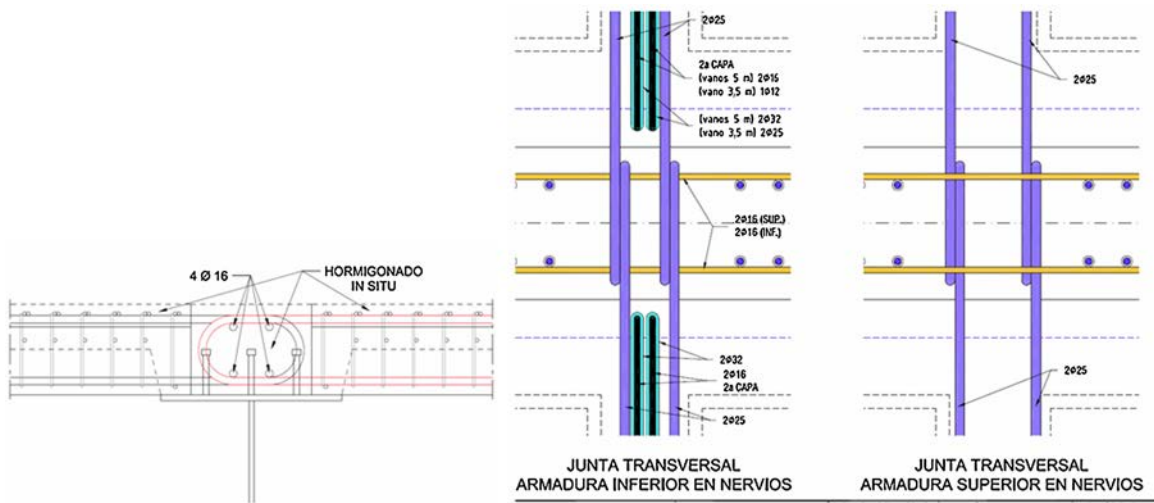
Solución para solape de armadura longitudinal de losas prefabricadas en juntas transversales.
